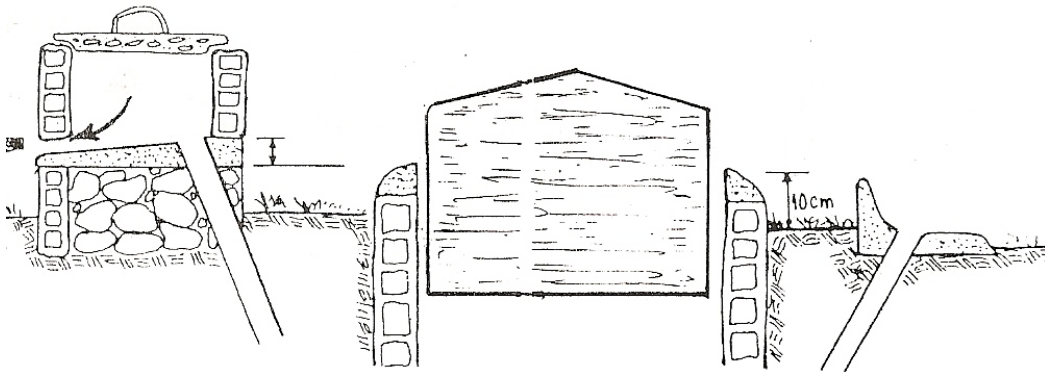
Construcción de la Caja de Carga y Descarga.
